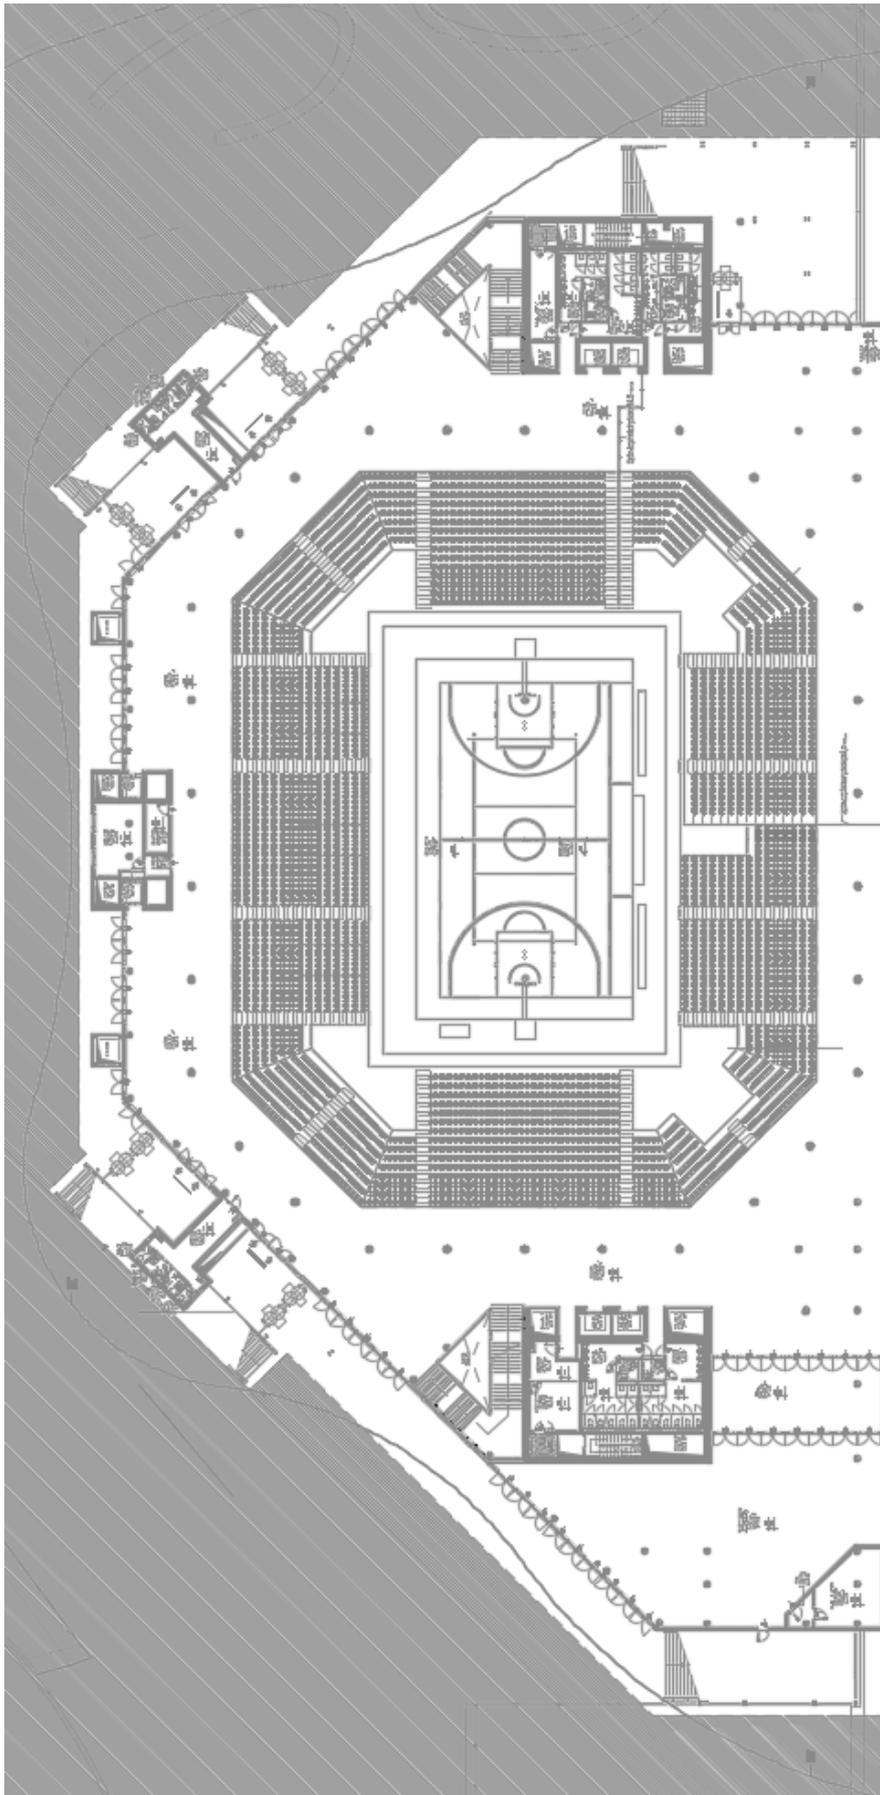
Pianta piano primo (Fonte: Studio GAe Engineering)
